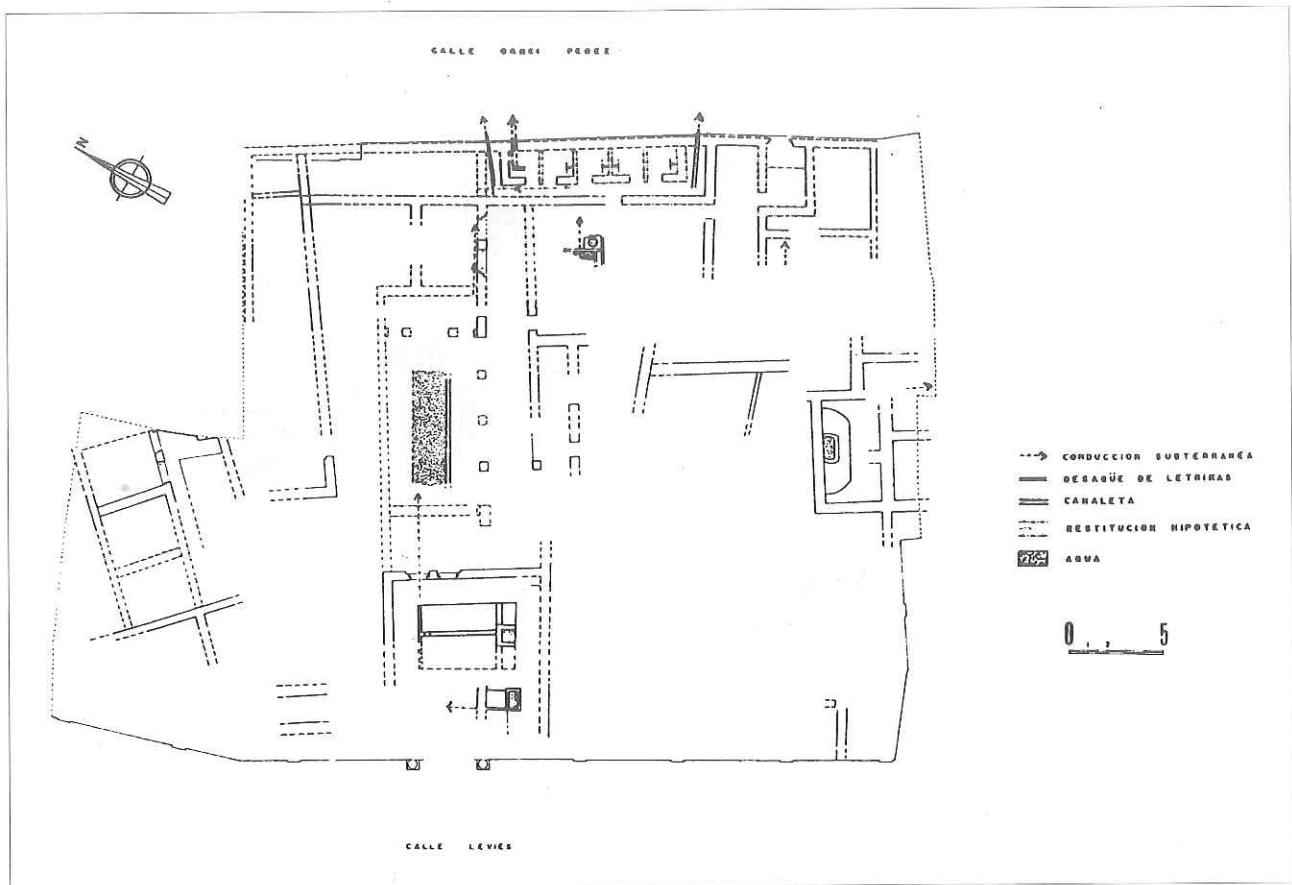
Restitución hipotética de la planta del edificio. Fase almohade
